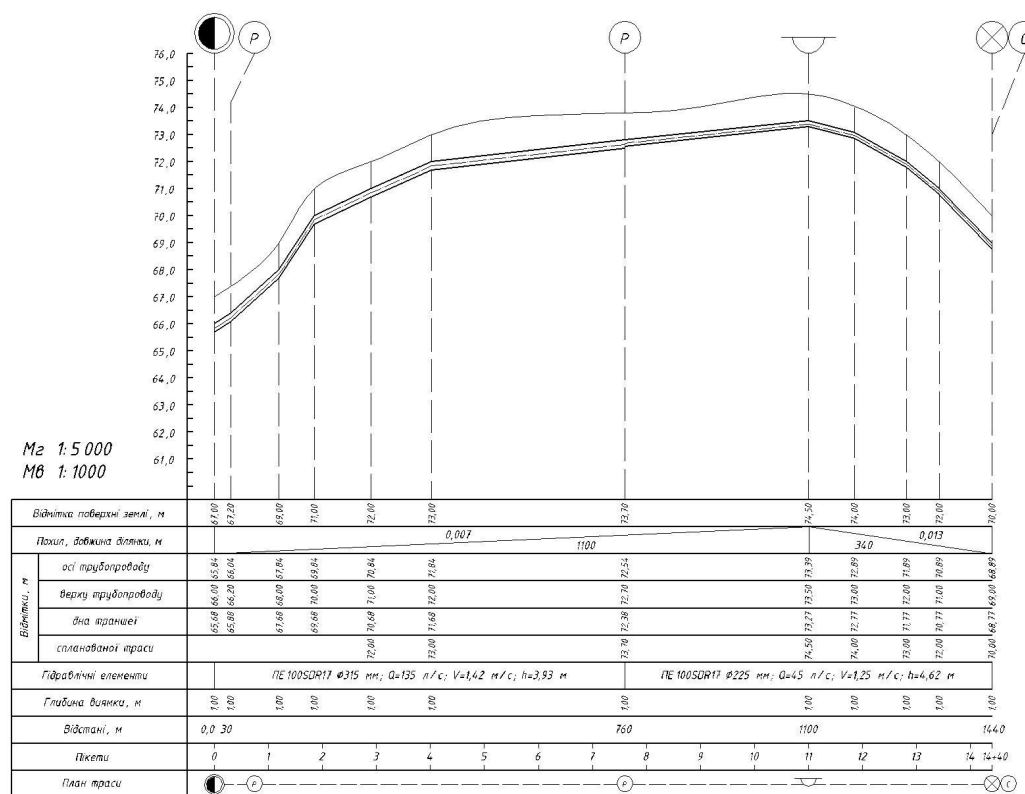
Поздовжні профілі трубопроводів КР-1 і КР-2.
